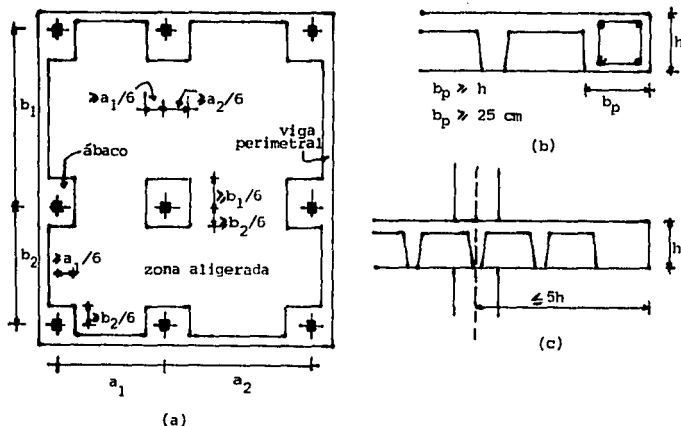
Recomendaciones para ábacos, vigas perimetrales y volados en losas planas aligeradas.
